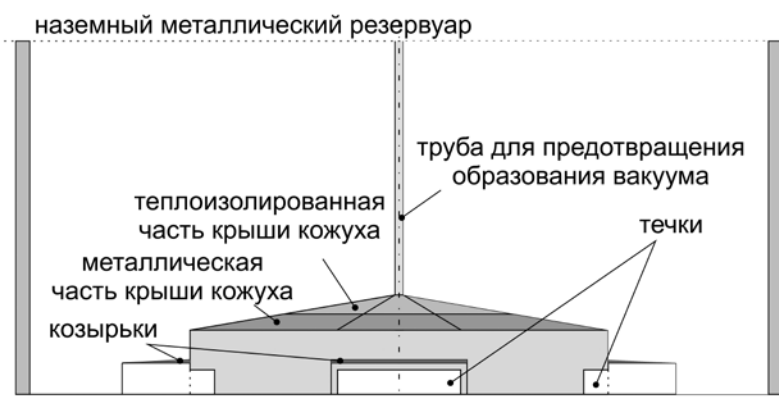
Резервуар для хранения битума с кожухом для локализации нагрева
